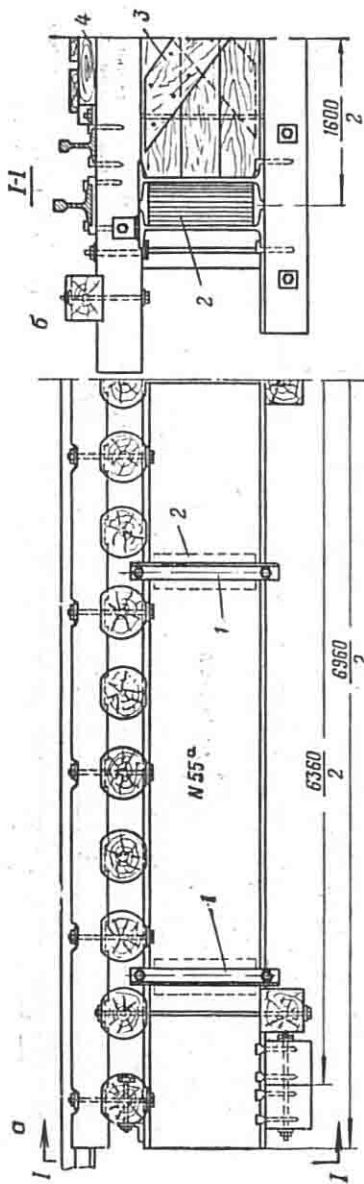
Пролетное строение из четырех двутавровых блоч № 55а с дерево-металлическими связями: а — фасад; 1 — уголки хомута 80 X X 80 X 10 мм; 2 — прокладка из деревянного бруса; б — в-ца с торца;
